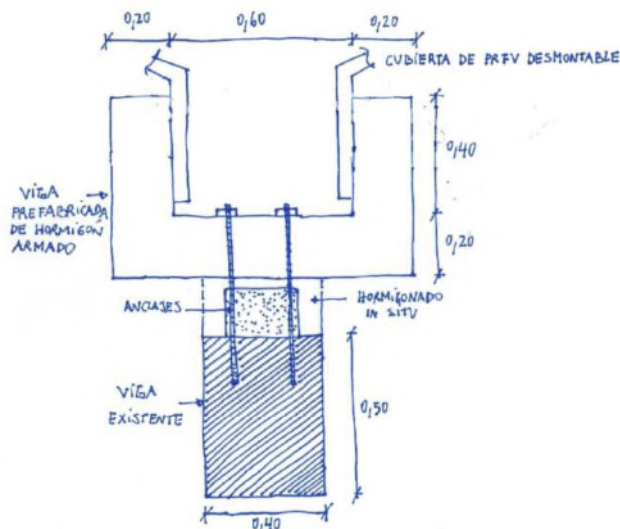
Viga canal de hormigón armado prefabricado en forma U de para apoyo de la cubierta desmontable propuesta y con anchura suficiente para estancia de un trabajador.
